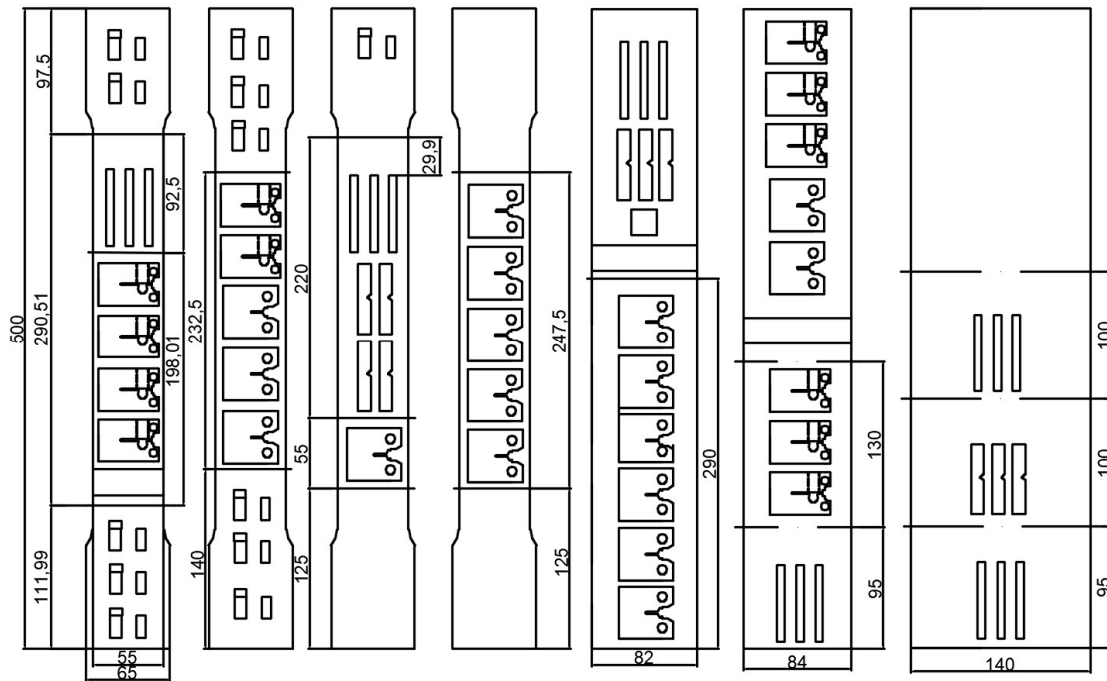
Esquema de probeteo a partir de las tejas G1 a G7 (de izquierda a derecha, dimensiones en mm).
